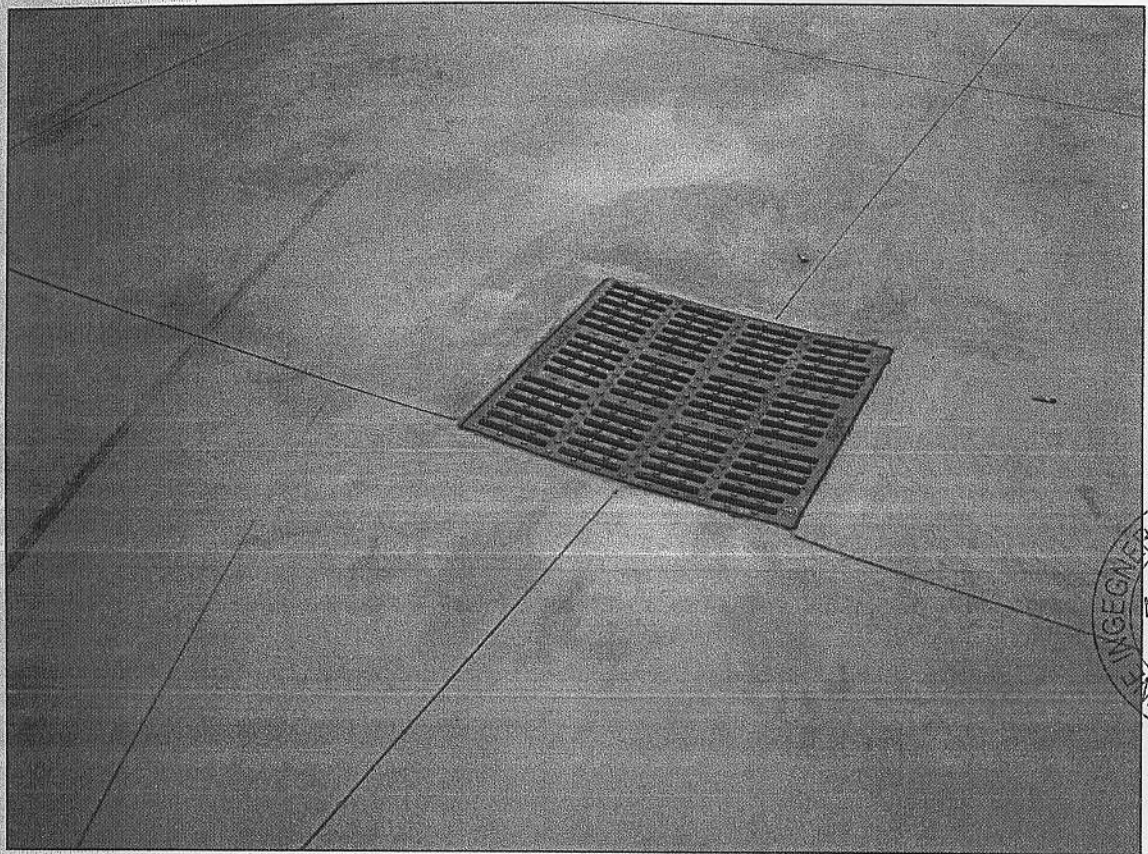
Caditoia della rete fognaria acque bianche posta ad una distanza intermedia tra la villetta n. 6 e la frontistante palazzina
